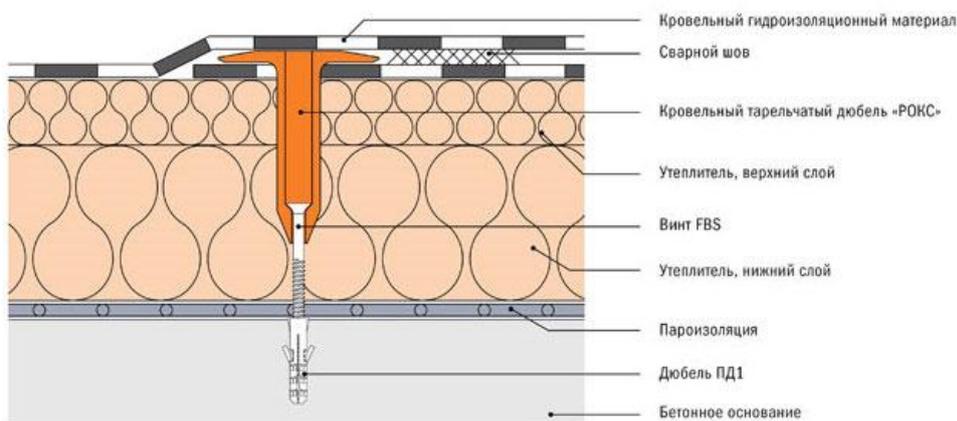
Узел механического крепления плоской кровли с бетонным основанием
